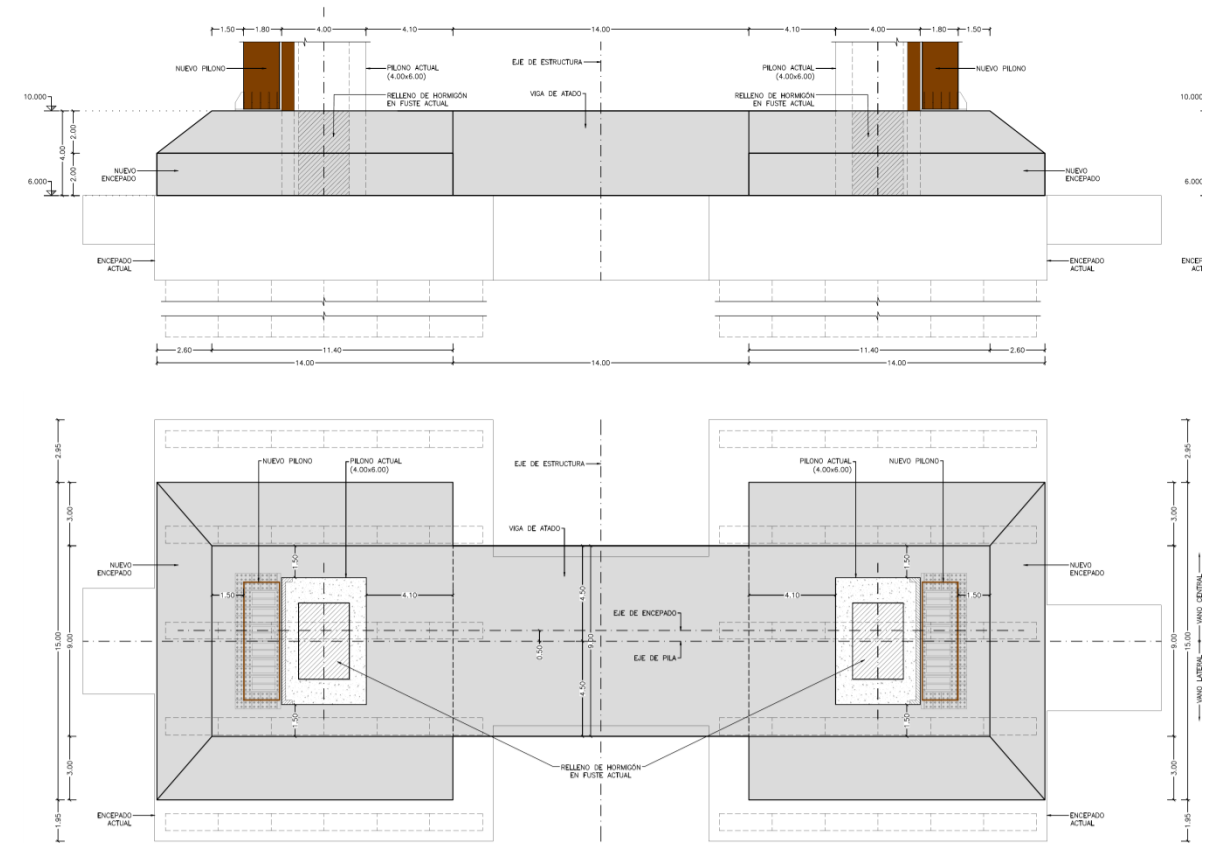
Alzado frontal (superior) y planta (inferior) de nueva zapata de pilonos sobre cimentación existente.
